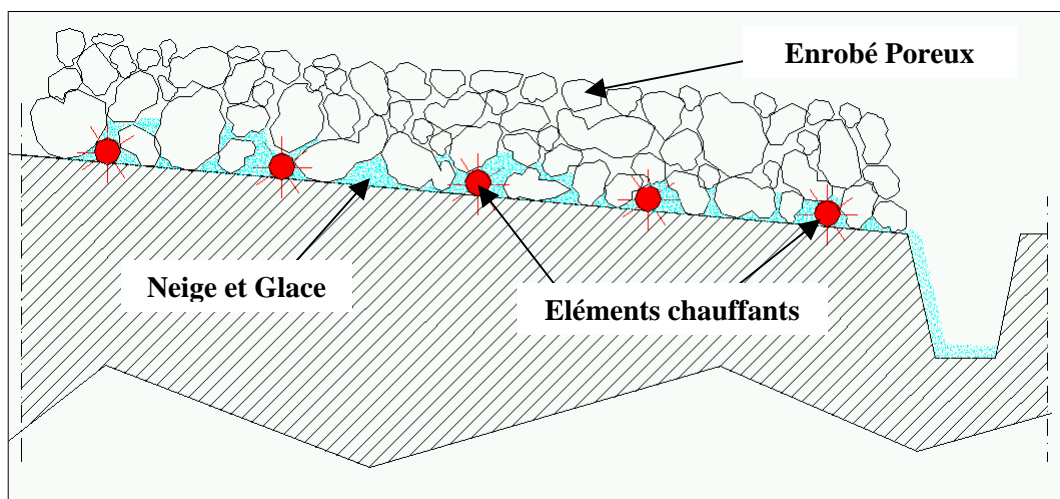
Schéma du Fonctionnement d'une Chaussée Chauffante
